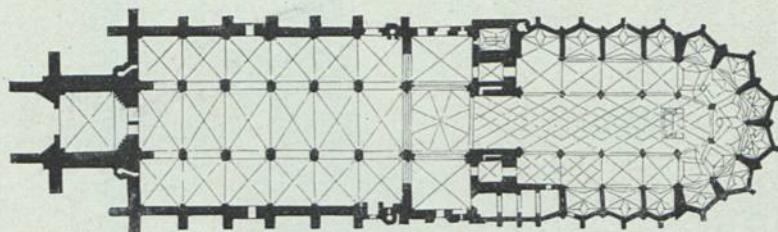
Grundriss des Münsters zu Freiburg
